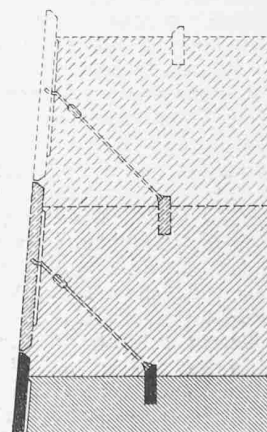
Verlorene Betonschaltafeln mit Stahlanker
